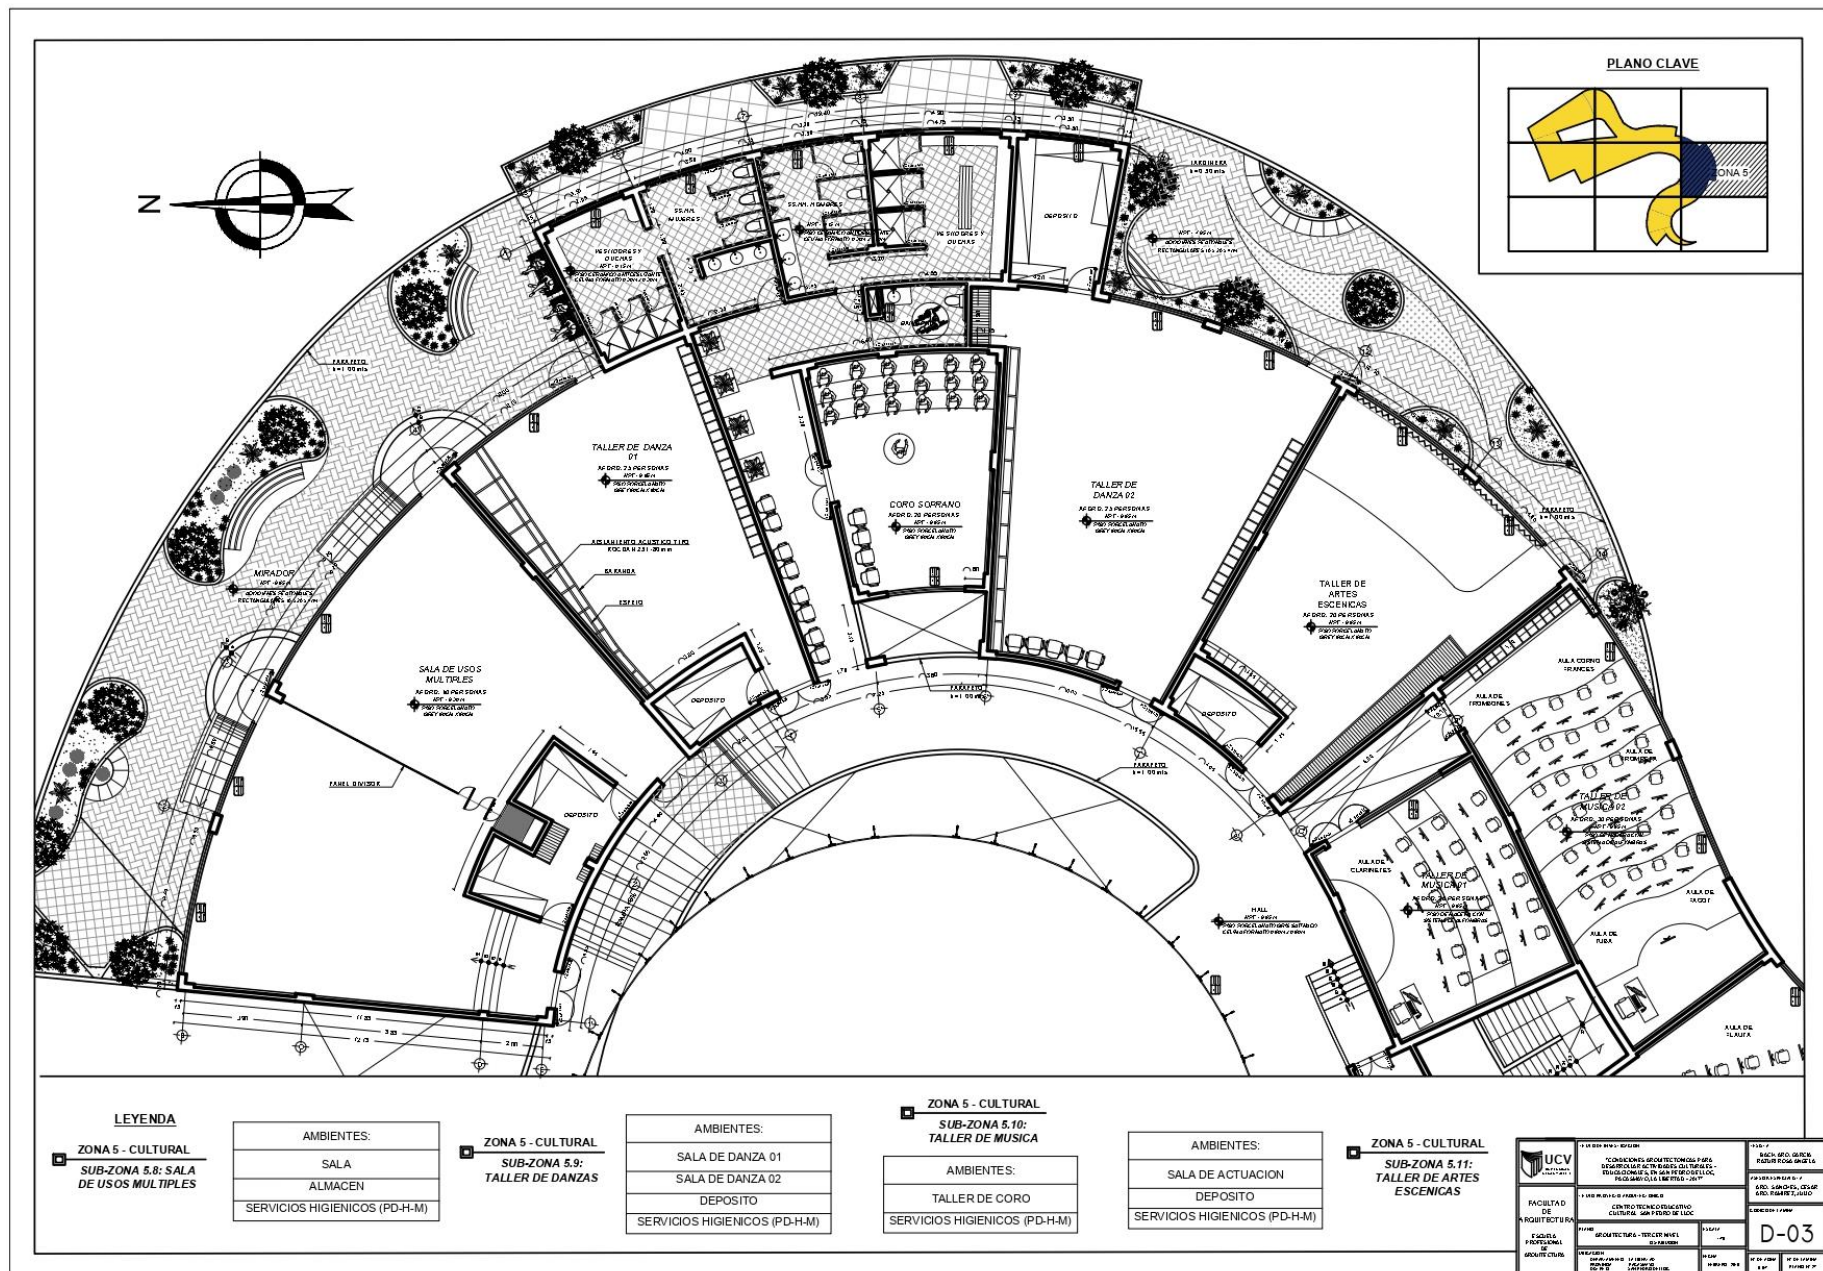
Plano de Desarrollo por Zonas - Plano N° 27 - Lamina N°: D - 03
